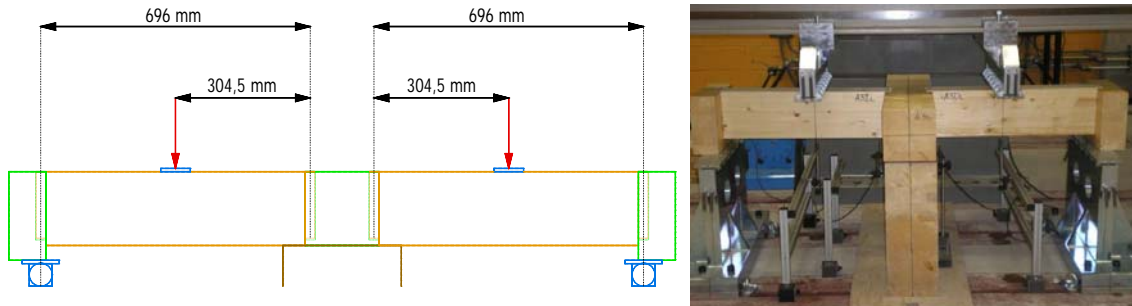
Distancia entre ejes de los apoyos y distancia de punto de aplicación de la carga al eje de la espiga del apoyo sobre la viga central
